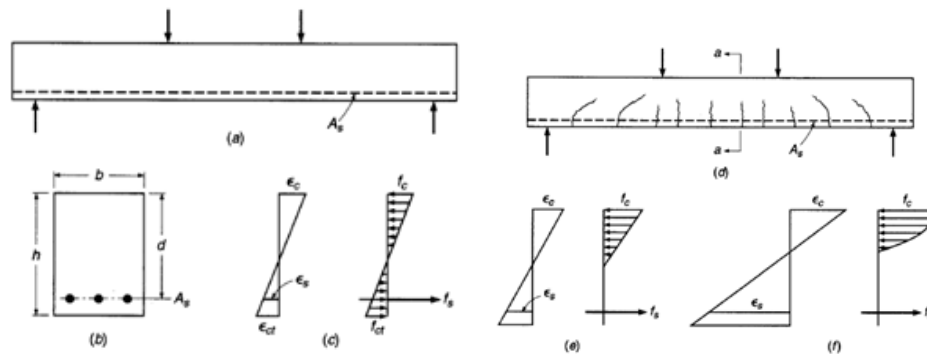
Comportamiento de vigas de hormigón armado frente a cargas crecientes.
